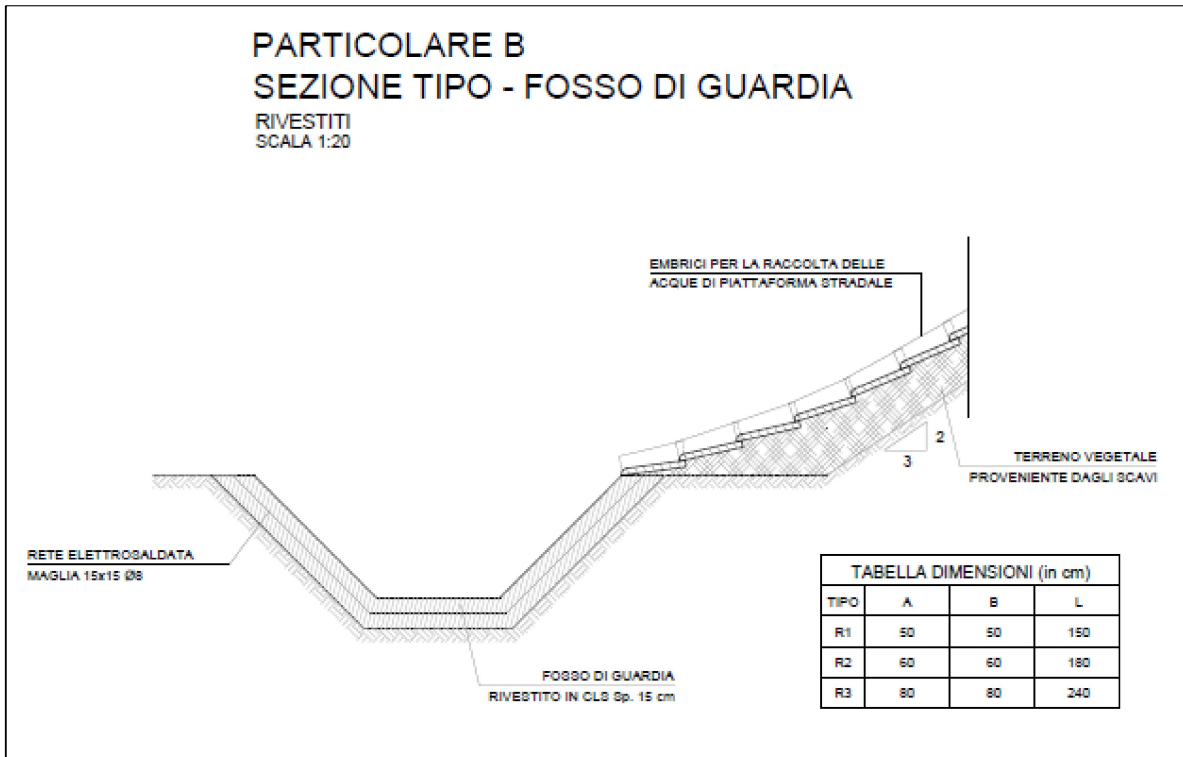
Schema del drenaggio per sezioni in rilevato – Fossi di guardia
